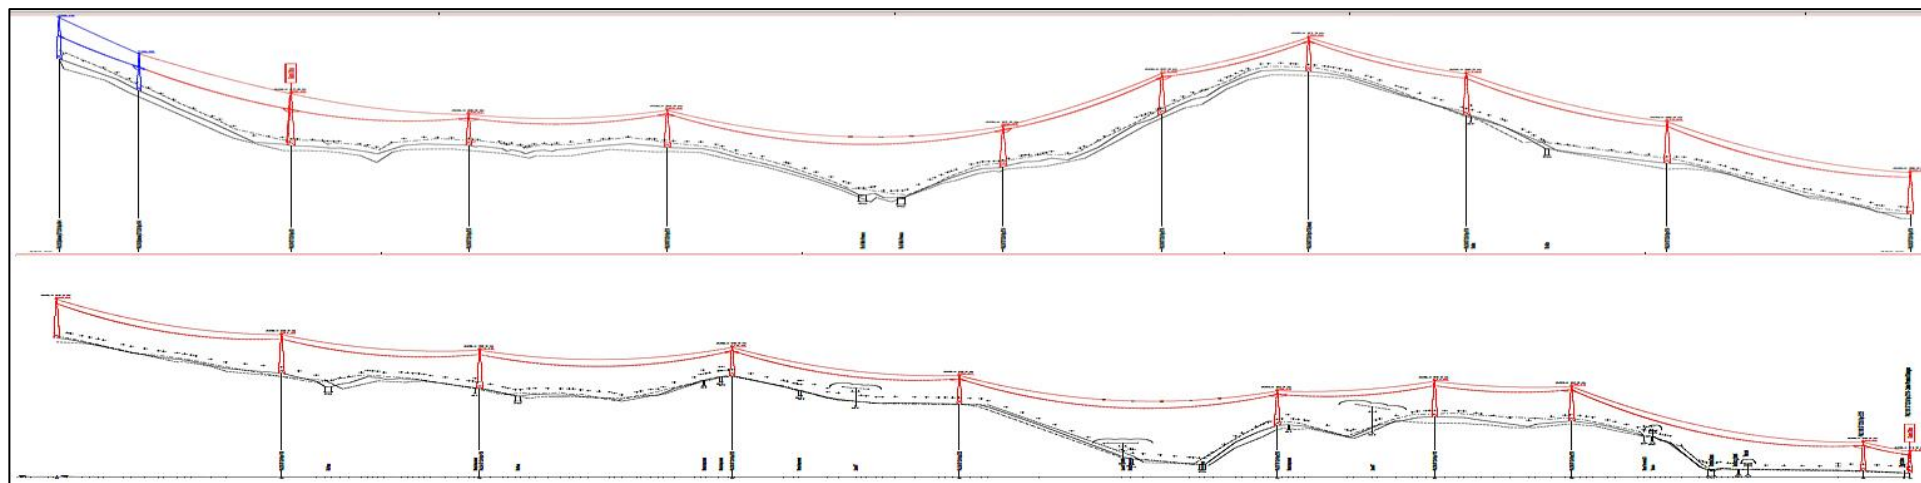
/1 - Tratto da "Progetto Definitivo - Profilo Altimetrico Linea T 919 e T 920 Rosone - Sud - Ovest
